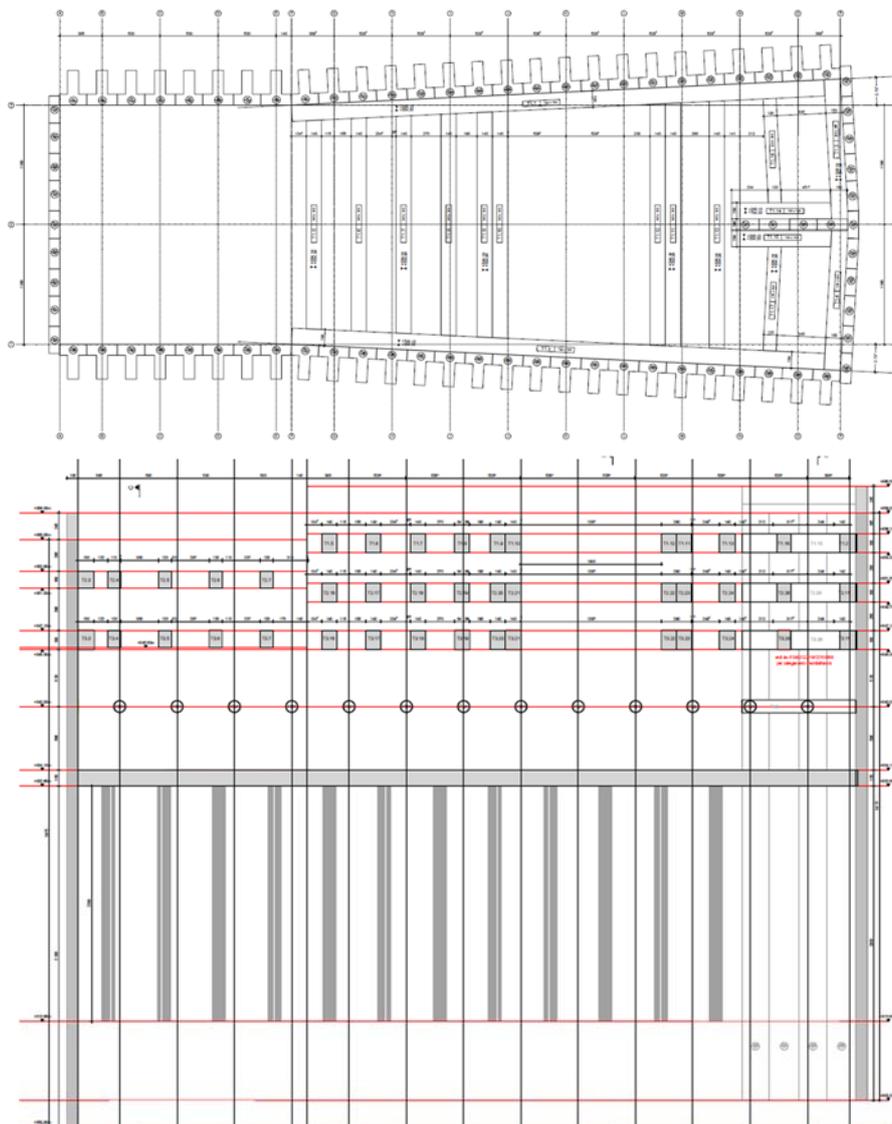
Stralcio planimetrico e sezione longitudinale del pozzo
